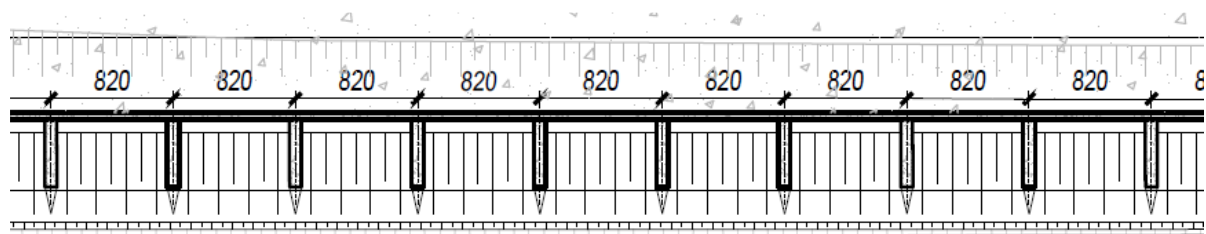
Stralcio pianta corrente infrastrutture di banchina (Relazione Illustrativa Opere Marittime, Elaborato "D-OM-PR-D01-0")
